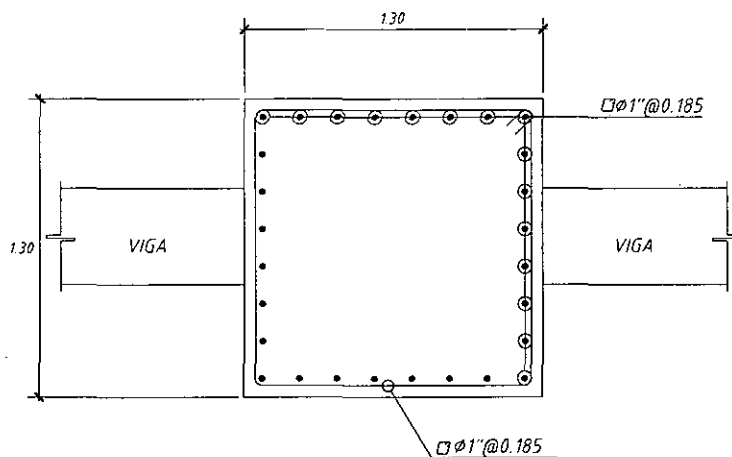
Corte 1 en el capitel, muestra el acero en planta y el acero horizontal de las caras laterales.
